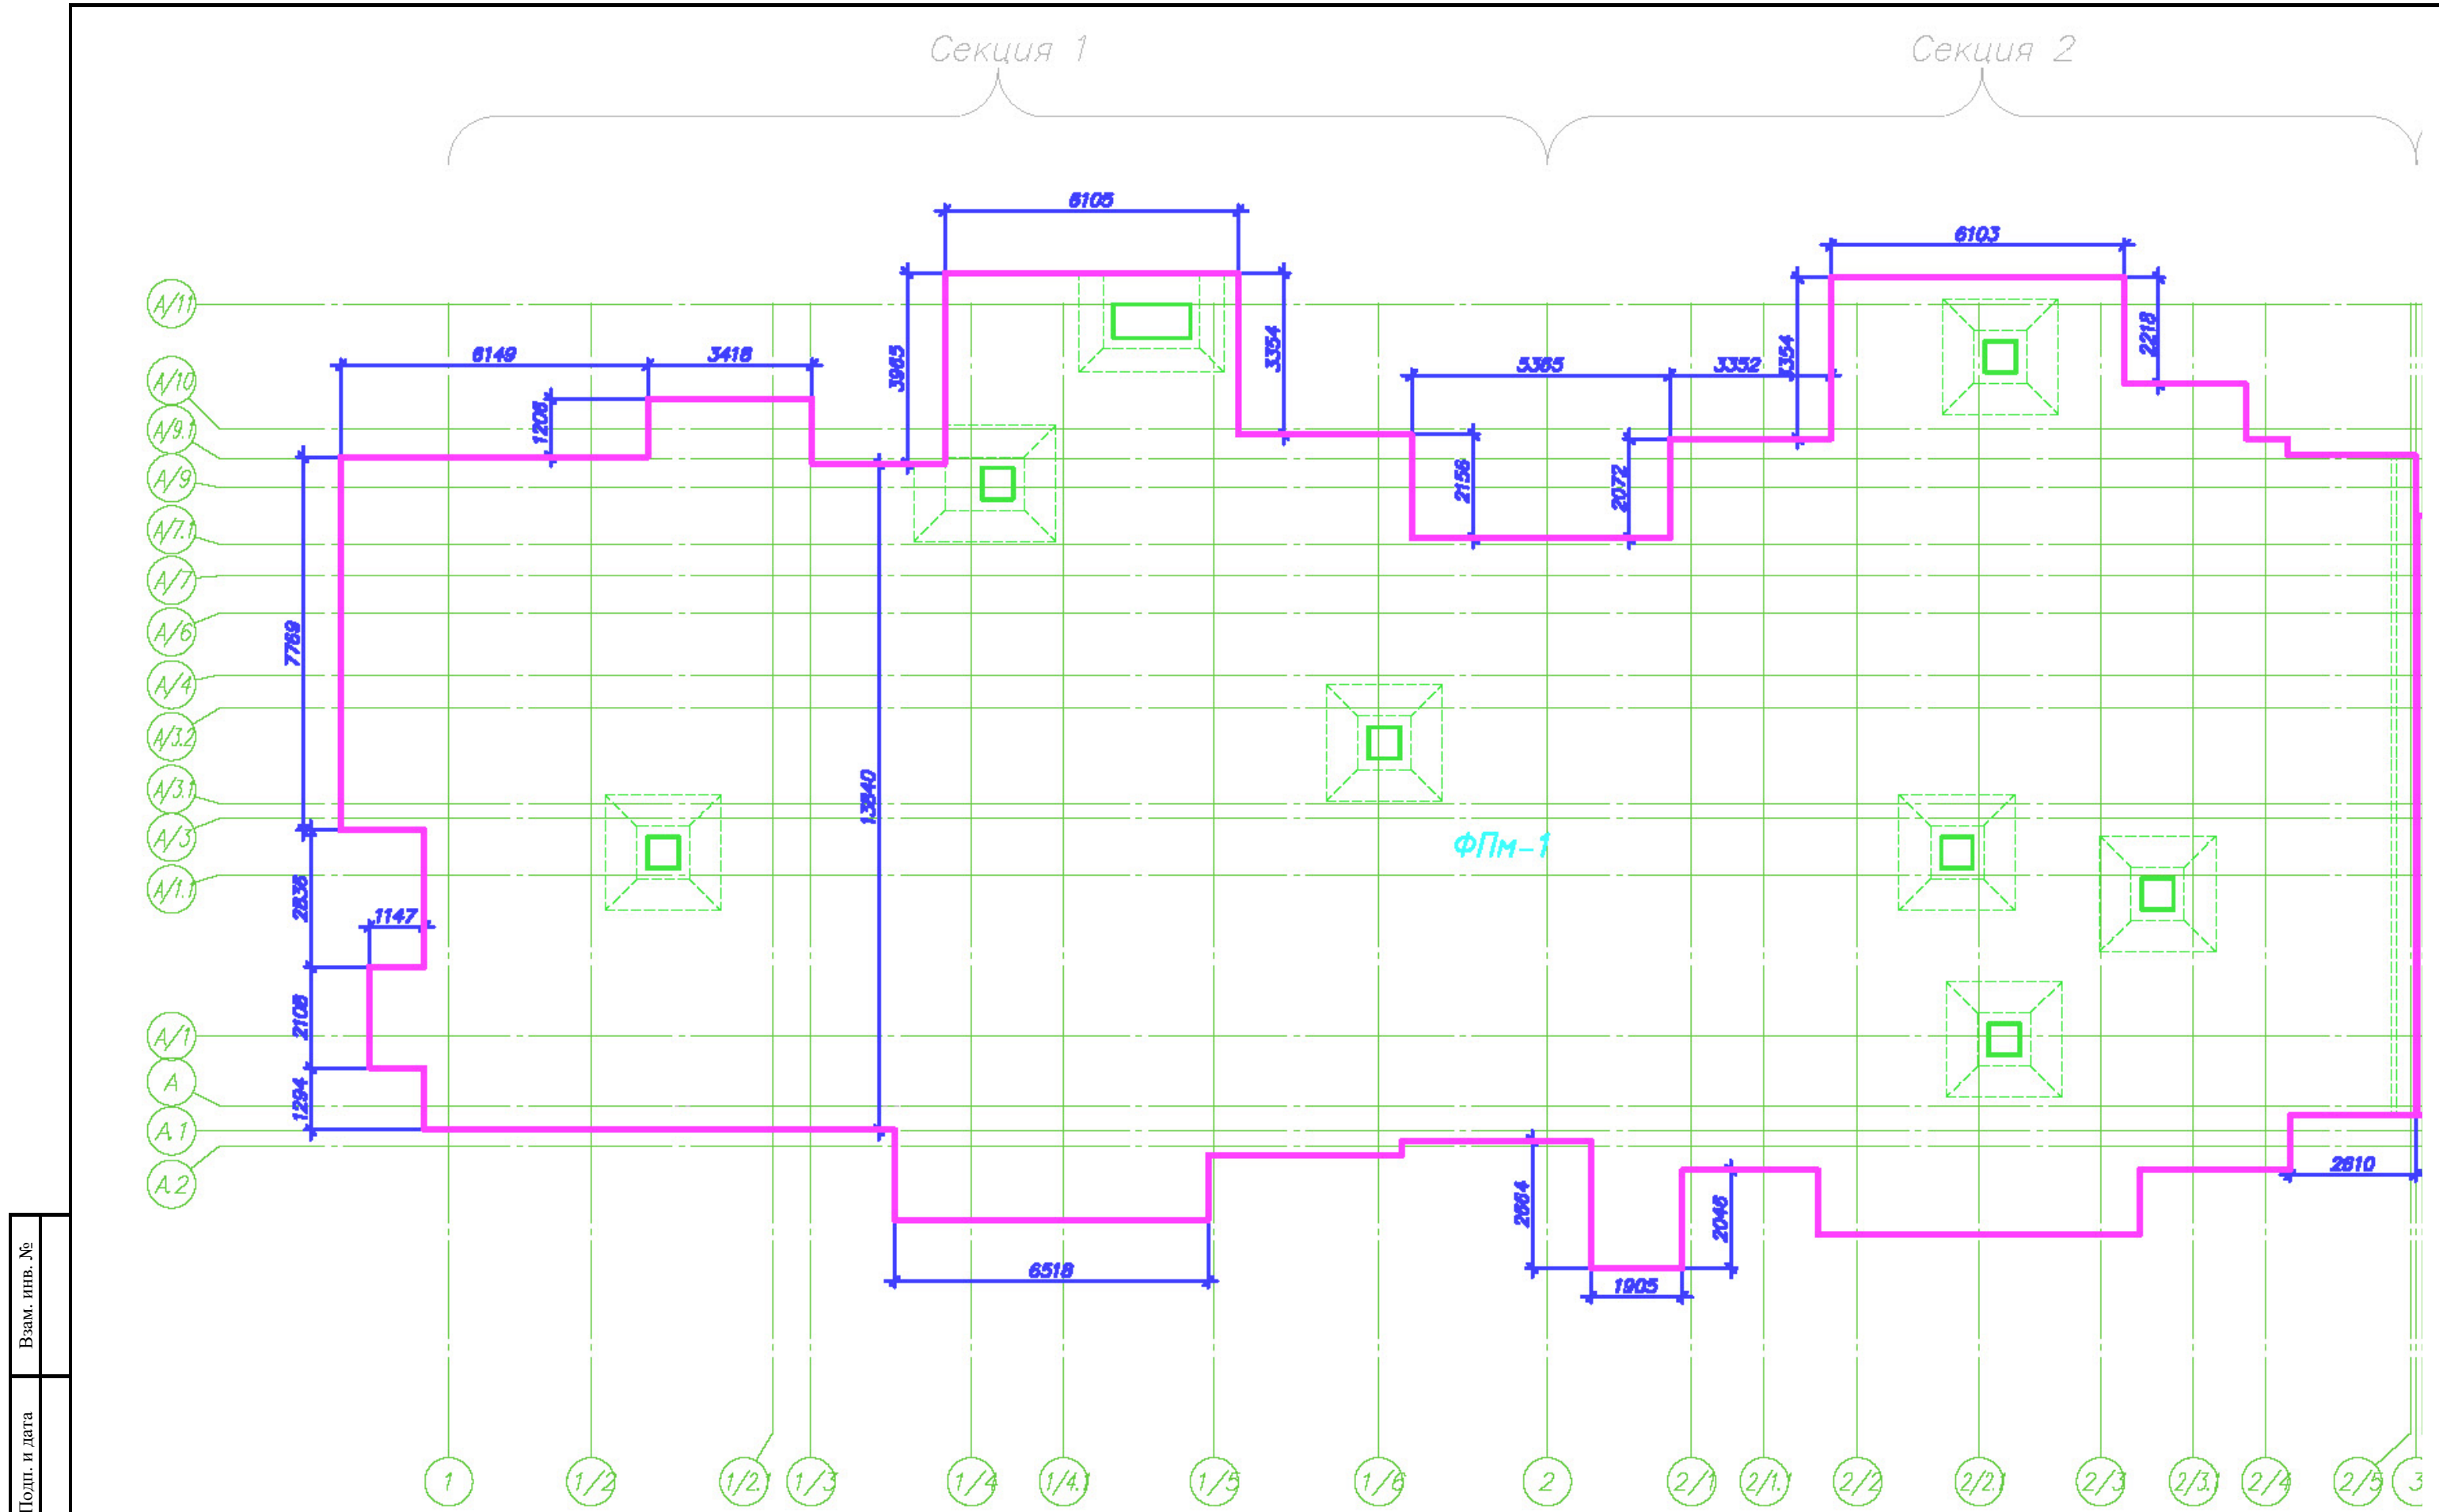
Обмерочный план фундаментной плиты ФПМ-1 секций № 1-2
